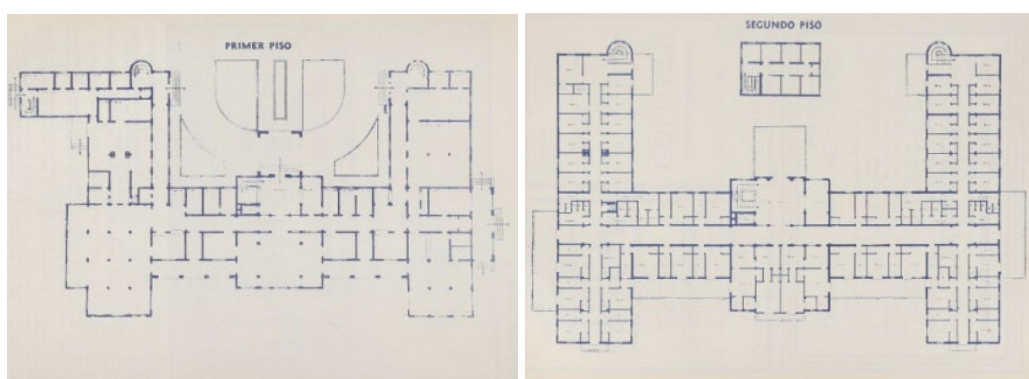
Planta primer piso. Fuente: Revista *En Viaje* N°4. Febrero 1934. Figura 25. Planta segundo piso. Fuente: Revista *En Viaje* N°4. Febrero 1934.
